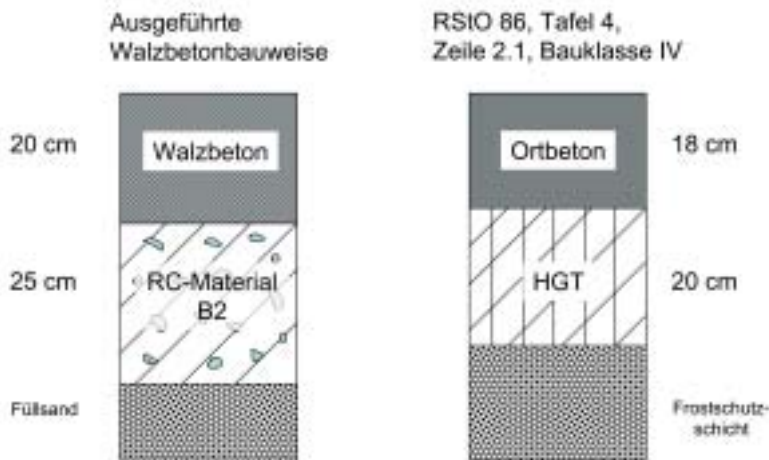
Schichtenaufbau der ausgeführten Walzbetonbauweise im Vergleich zur Bauweise nach RStO 86, Tafel 4, Zeile 2.1
